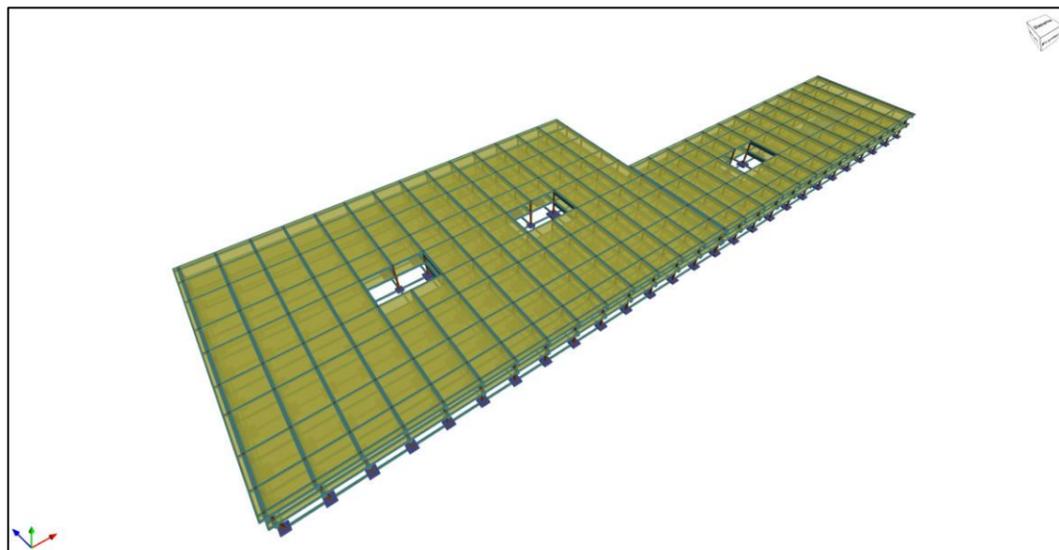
Vista en planta de la estructura Tipo 1: Losa. Fuente: Elaboración propia CYPE
